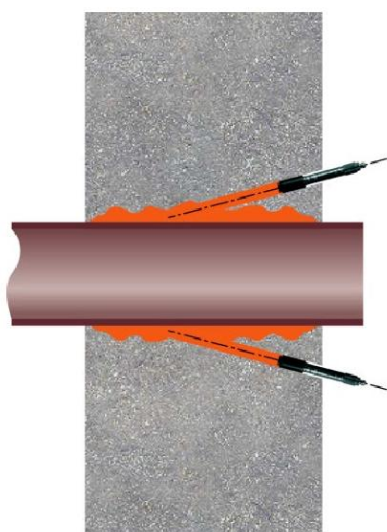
Injeção para impermeabilização de atravessamentos de tubagens (Sotecnisol, 2009).
